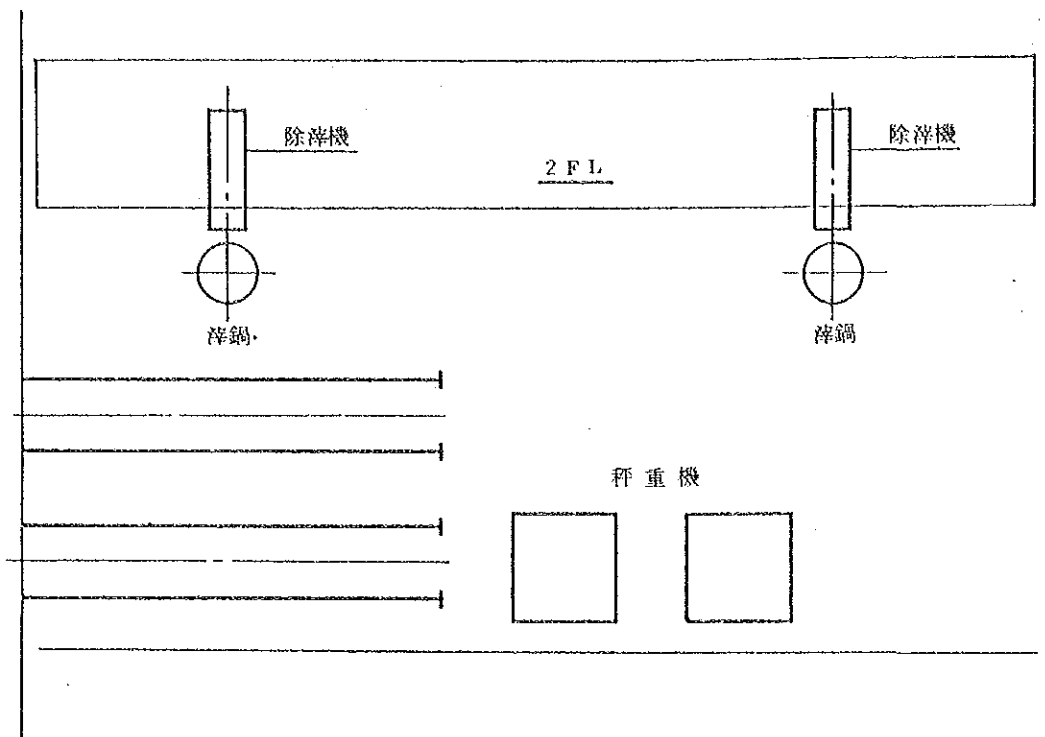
5 - 1 0 溶銑ヤード平面配置図
